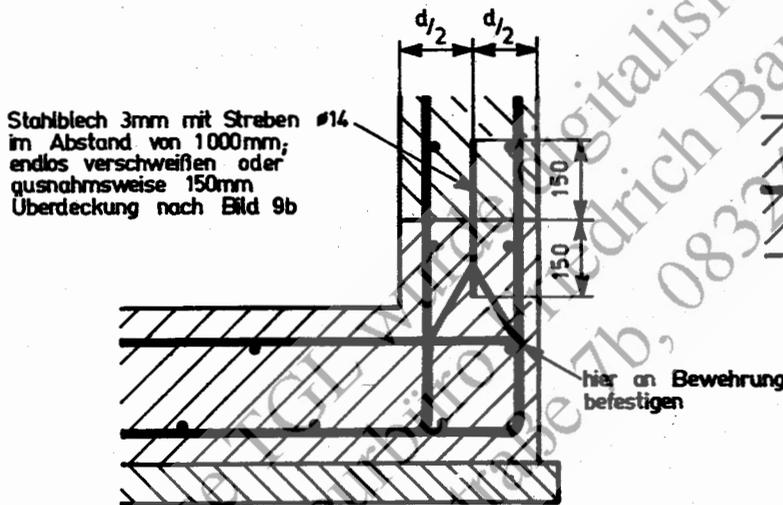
Arbeitsfuge mit Stahlblecheinlage
